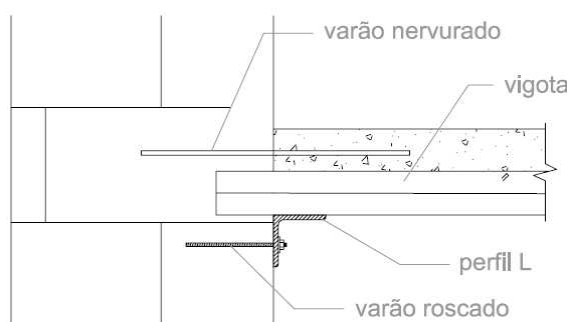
Apoio da laje aligeirada através de perfil L.
